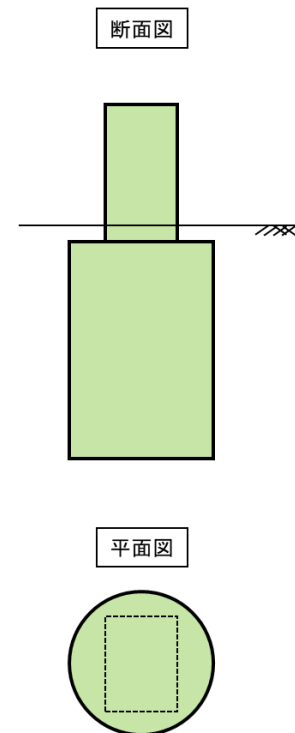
下部工（ニューマチックケーソン基礎）の施工手順
